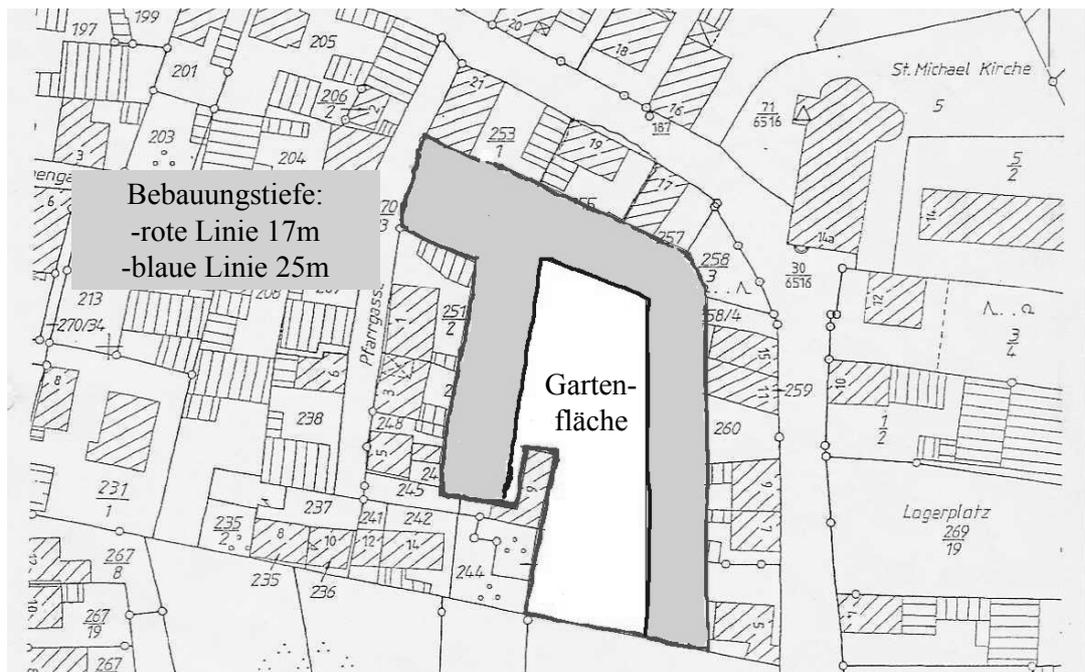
Östlich der Pfarrgasse, Planungsstand 2003
